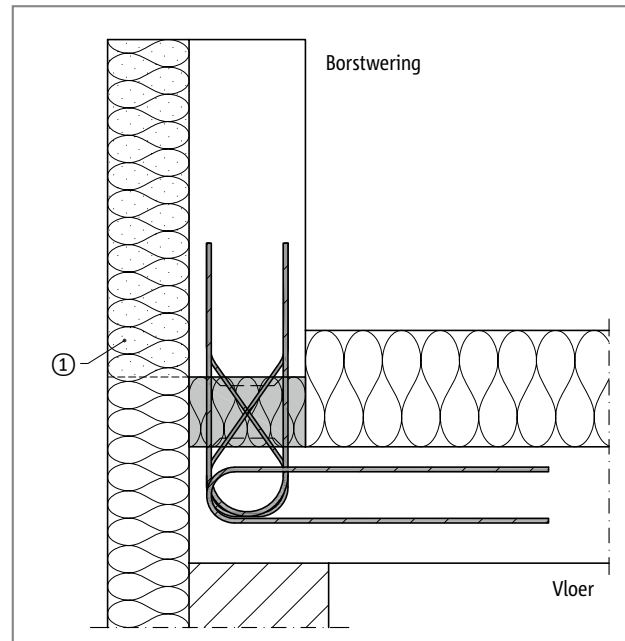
Schöck Isokorb® T type K: Aansluiting met vensterdetail boven en onder de aansluiting
